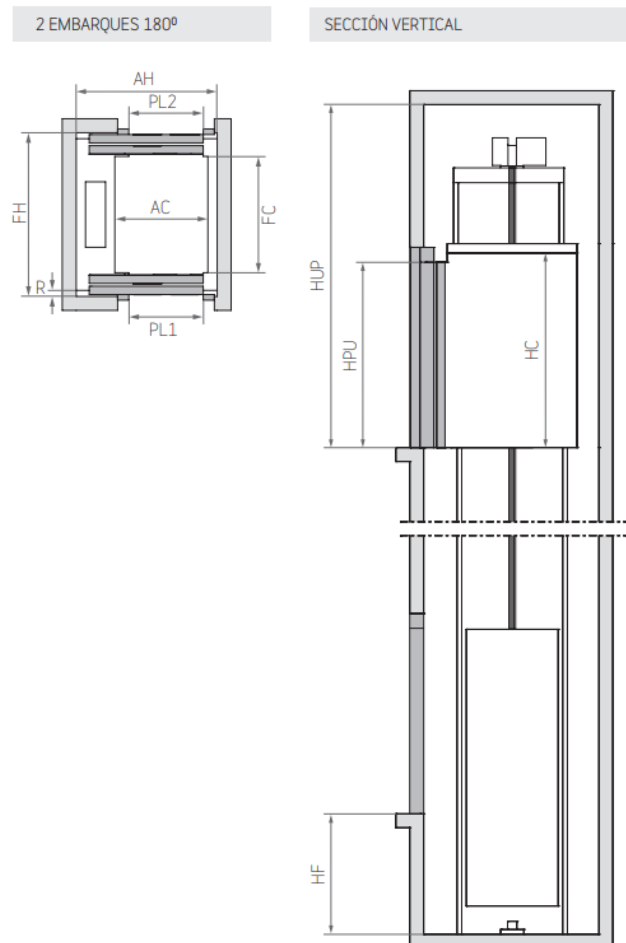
Dimensiones del acceso superior. Fuente: autor
